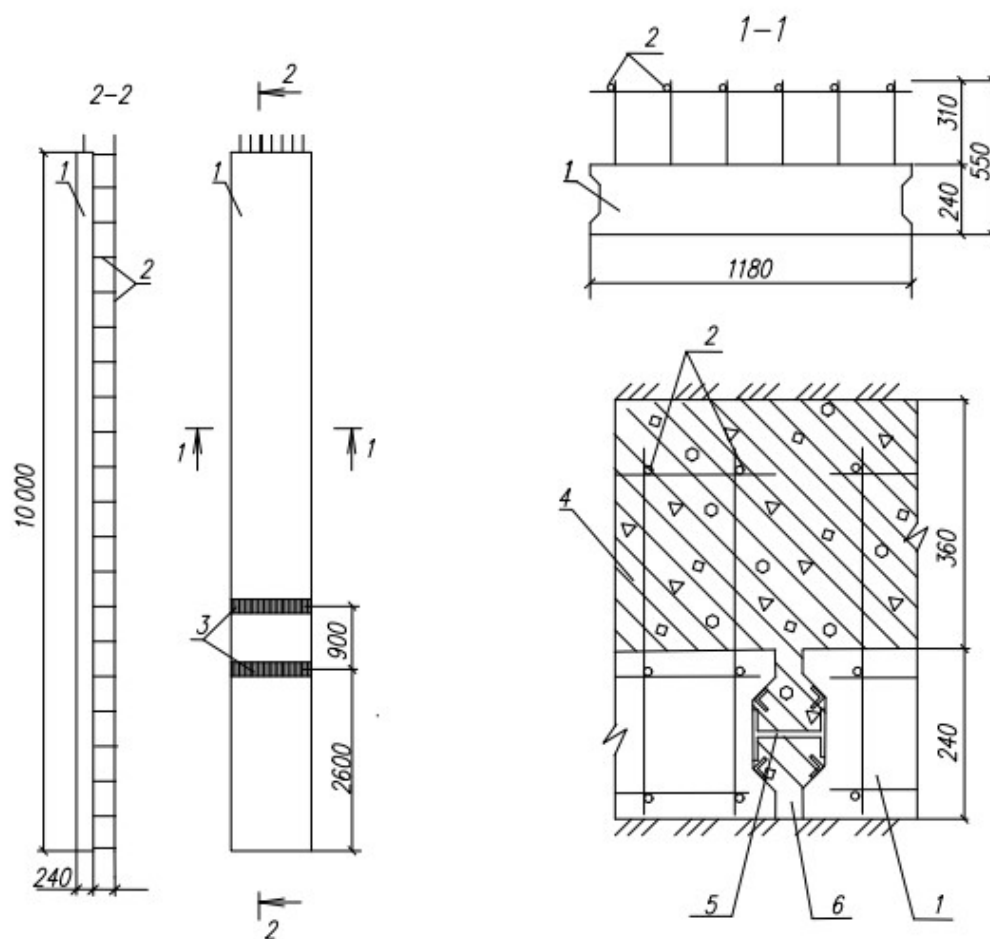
Схема стеновой панели и приспособление для её монтажа в траншее: 1 – панель стеновая; 2 – выпуски арматурного каркаса из панели; 3 – деталь закладная стальная для крепления днища; 4 – монолитная часть «стены в грунте»; 5 – двутавр направляющий инвентарный для монтажа панелей; 6 – штраба между панелями вертикальная, заделываемая торкрет-бетонированием
